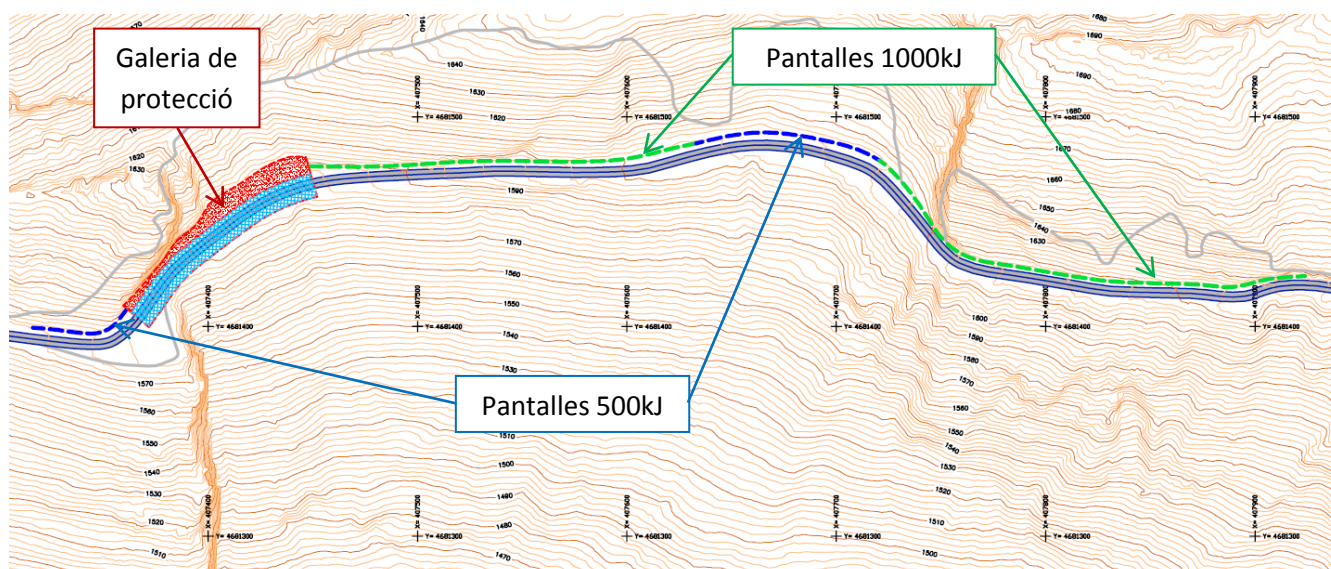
Disposició de les pantalles i la galeria de protecció en l'alternativa 2
